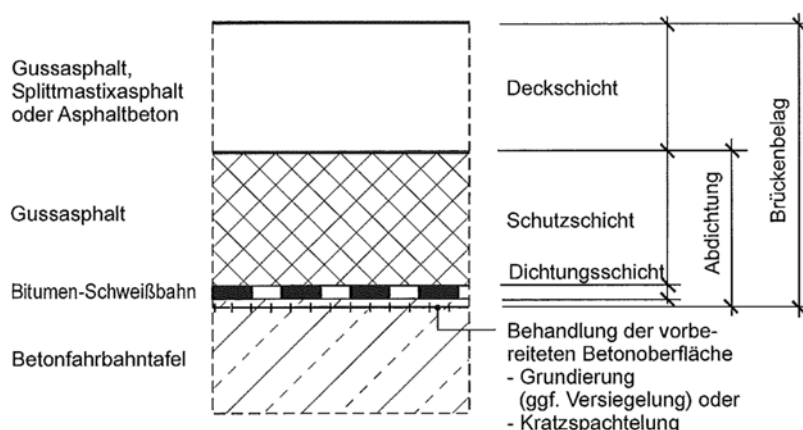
Systemaufbau auf Beton gemäss ZTV-ING Teil 7, Abschn. 1 [5]
